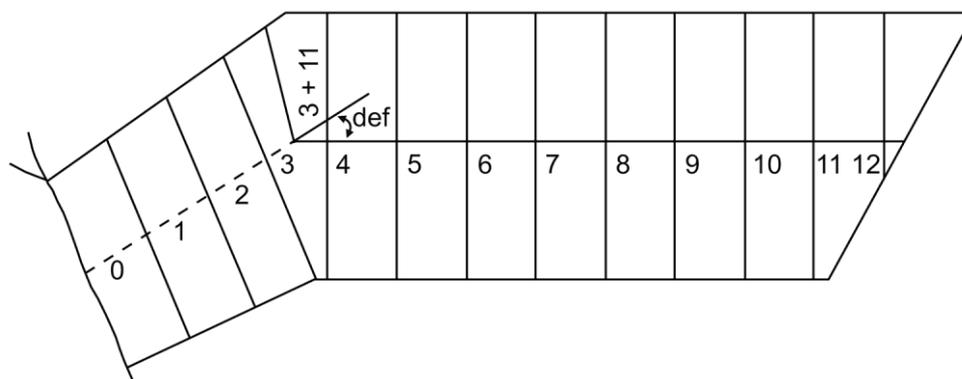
Representação esquemática do levantamento planialtimétrico pelas seções transversais
